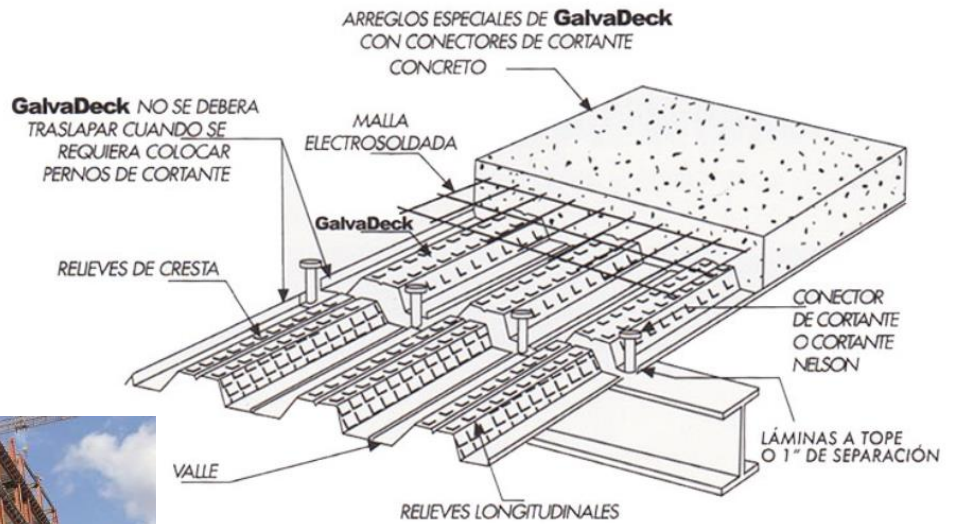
/ Estructura / Fuente: Búsqueda de imágenes
